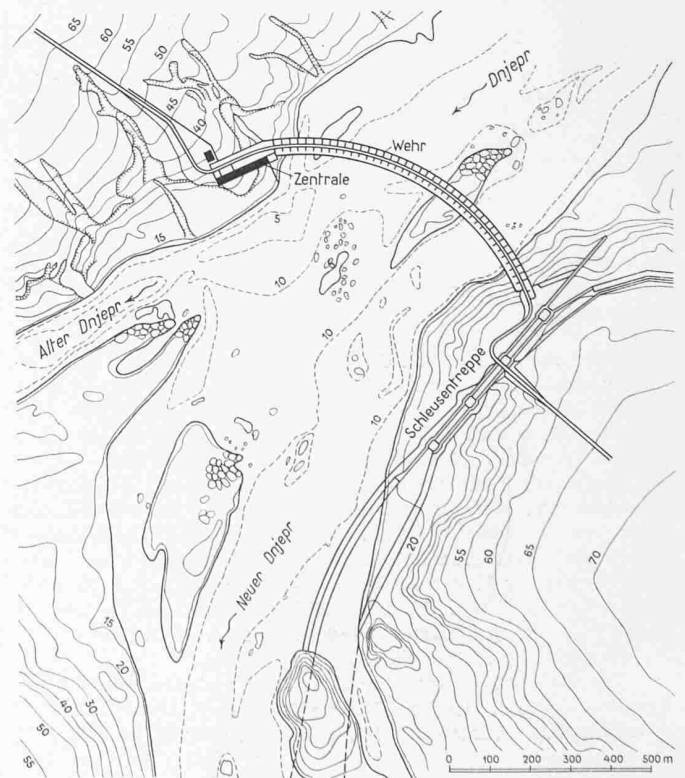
Kraftwerk Dnjeproströj, Lageplan 1 : 18 000
